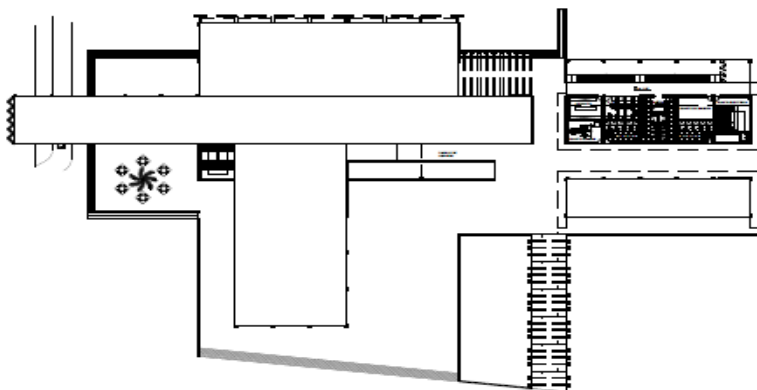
Segmentación por Volúmenes. Nave 4, Planta Baja. (2017)
